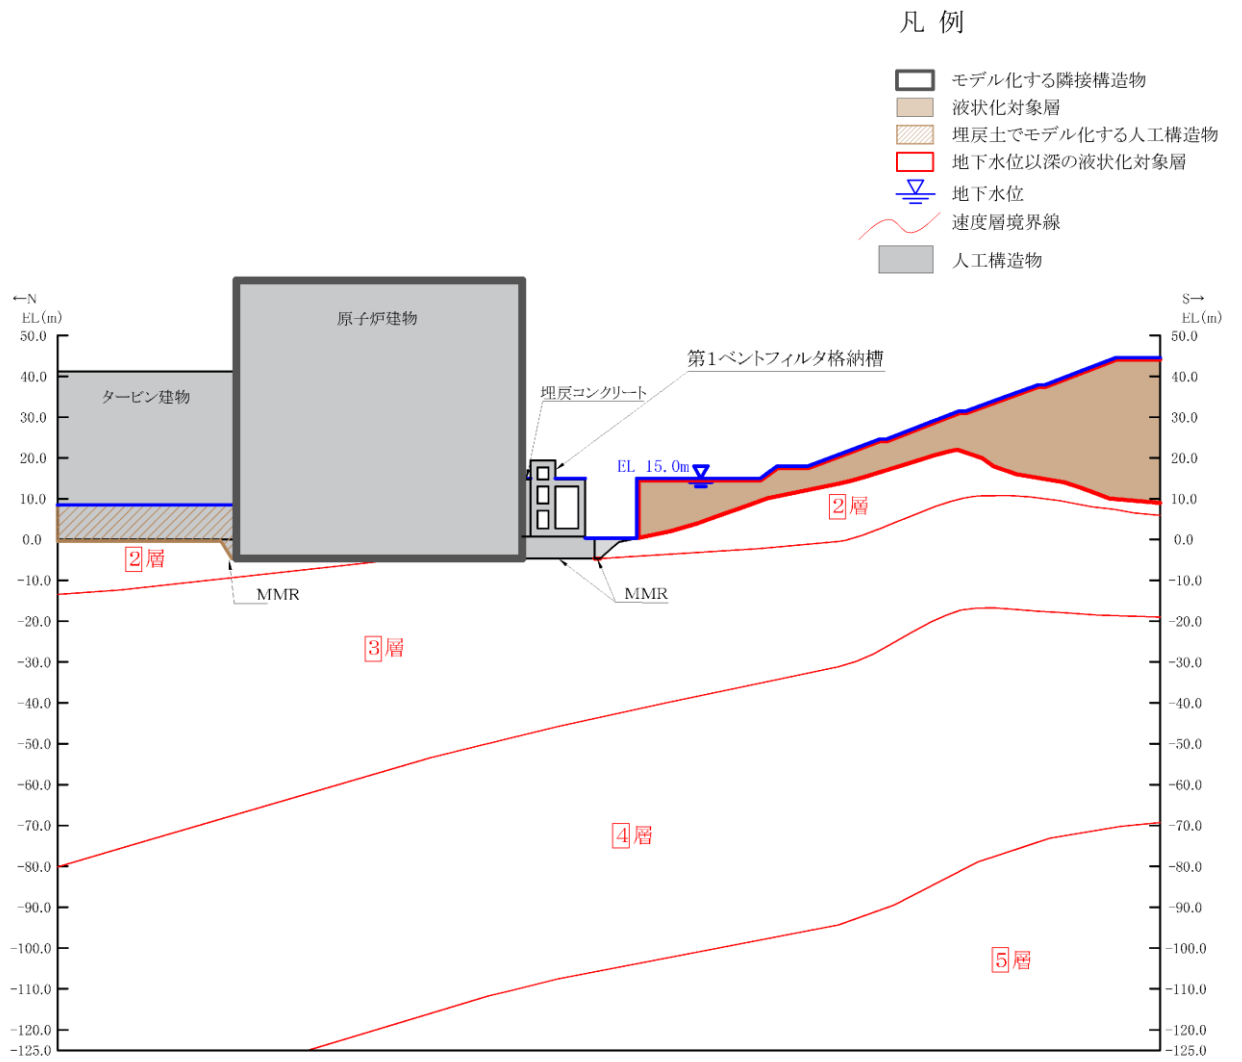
第 1 ベントフィルタ格納槽 評価対象断面図 (A-A 断面位置)
